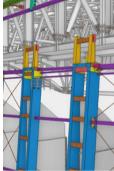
Modelo IFC: Fachada sur. Costillas en "diapasón" coordinadas con pilares de hormigón del graderío existente.
